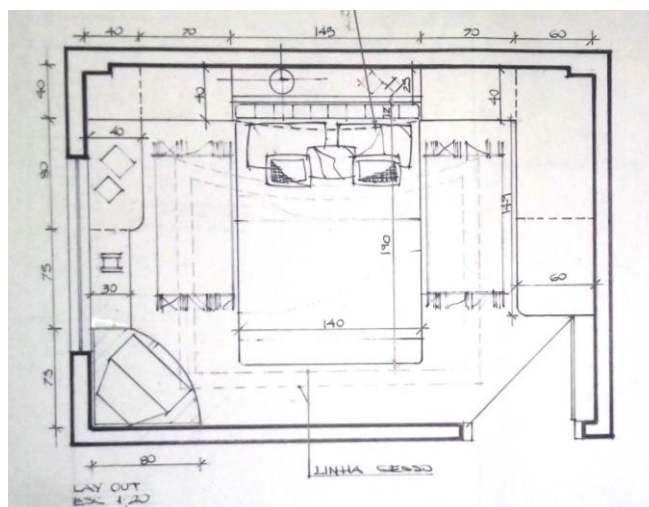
Planta Baixa do Quarto de casal da Sra. Daniele
